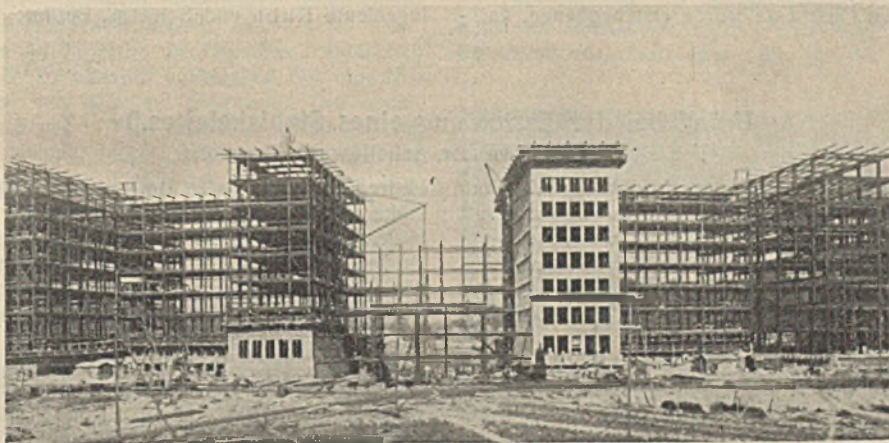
Montage der Eingangshalle mit den Blechträgern von 20 m Stützweite.
